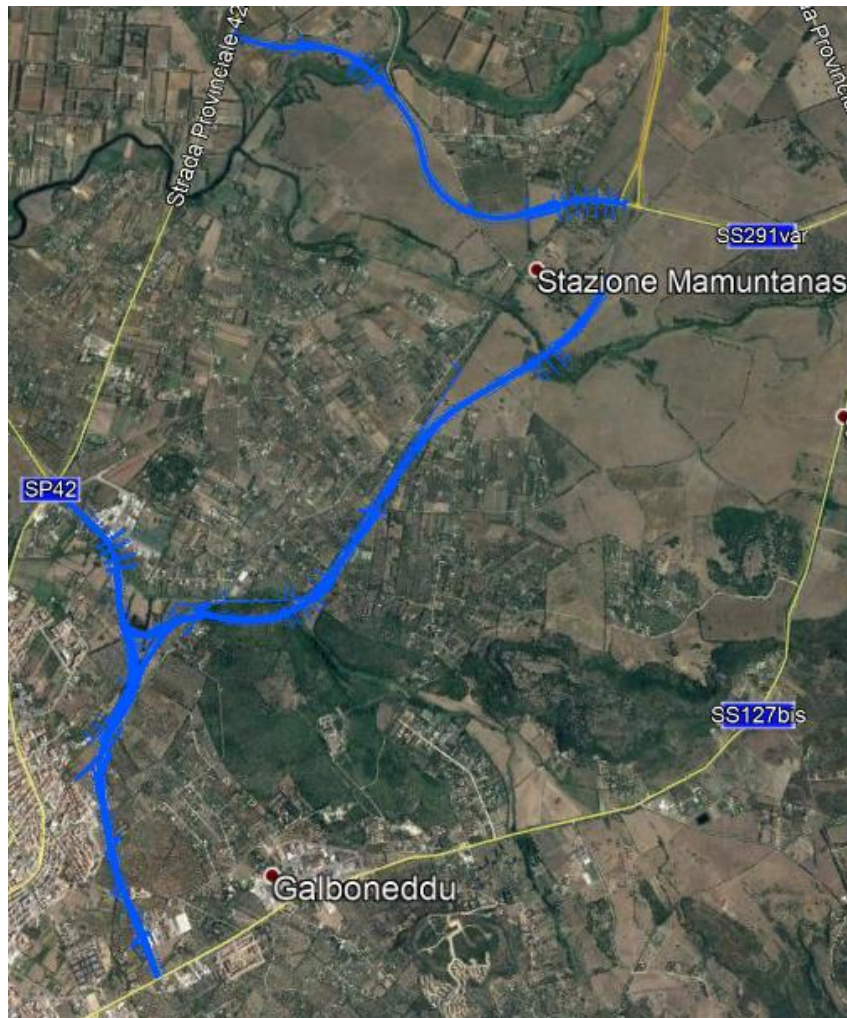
Localizzazione del tracciato di progetto su ortofoto
